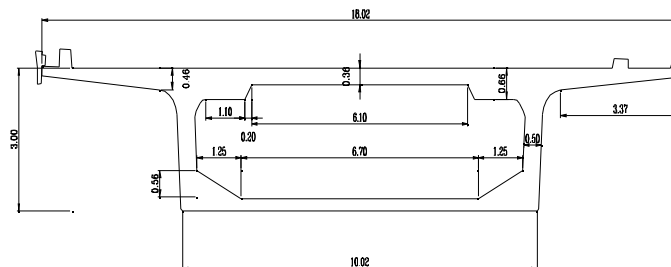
Corte transversal do tabuleiro na zona do encontro esquerdo e meio vão entre os pilares da ponte.
